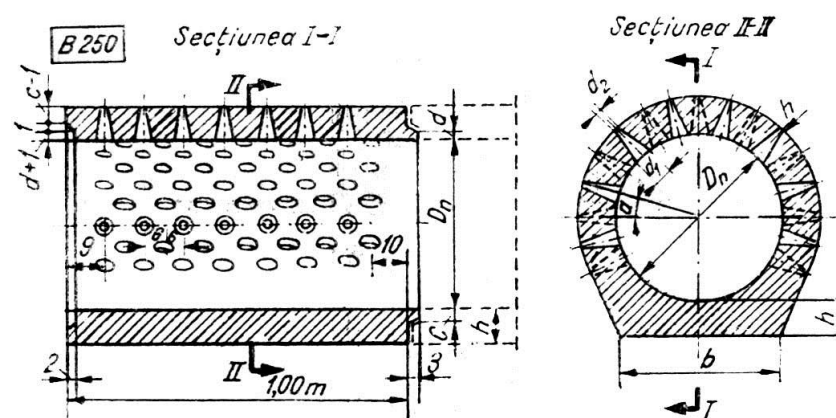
Elementele geometrice caracteristice pentru tuburile de drenaj din beton
